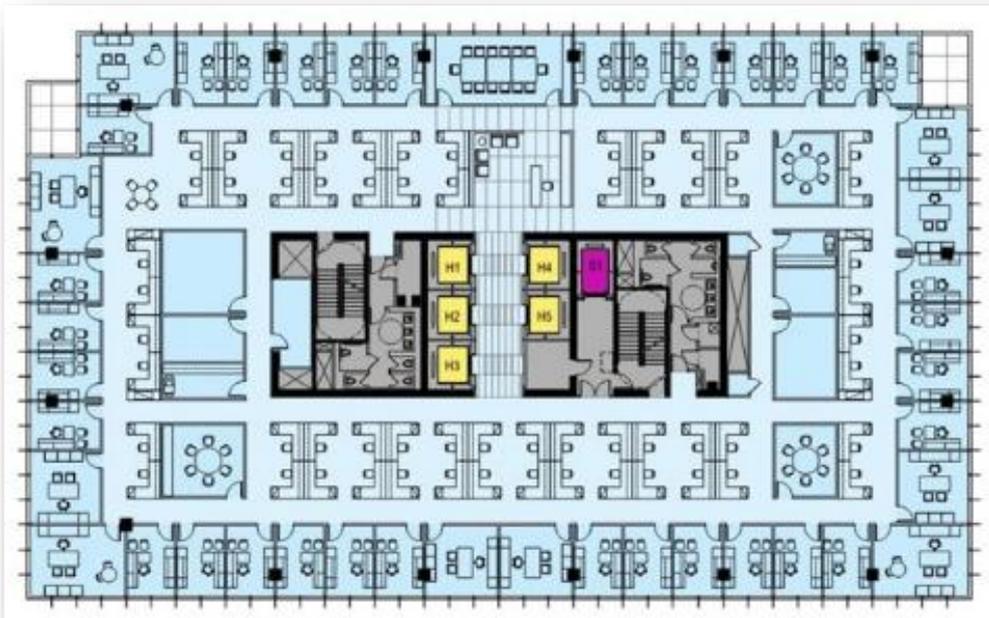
plan des étages de la tour Al Hilal source : <https://www.archdaily.com/>
